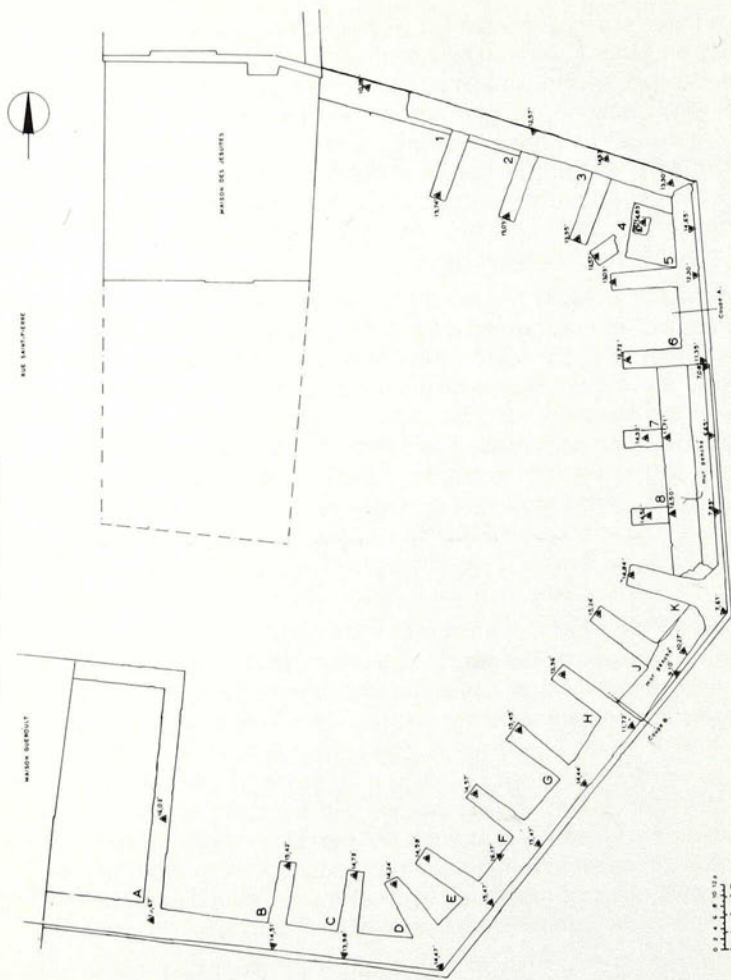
Plan général du site fouillé et des vestiges de la batterie (dessin de Danielle Filion-Naylor)
